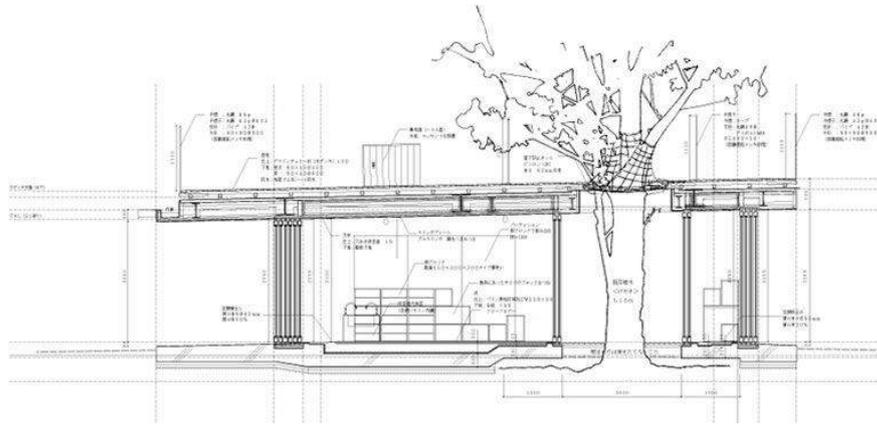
Guardería Fuji de Tezuka Architects. Sección constructiva (López del Río, 2017).
